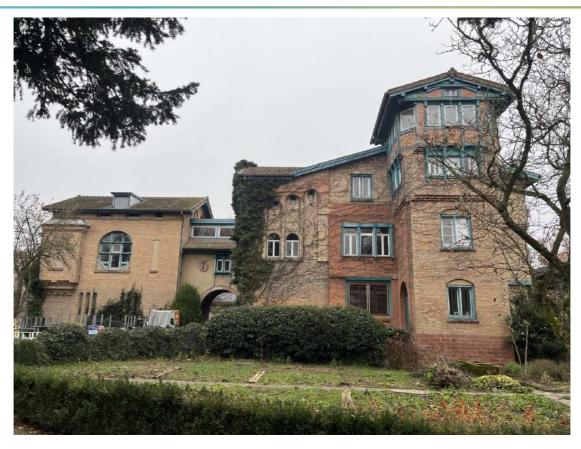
Vue générale de la façade Sud-Ouest du château avant travaux – Source ARCHIMED Environnement
